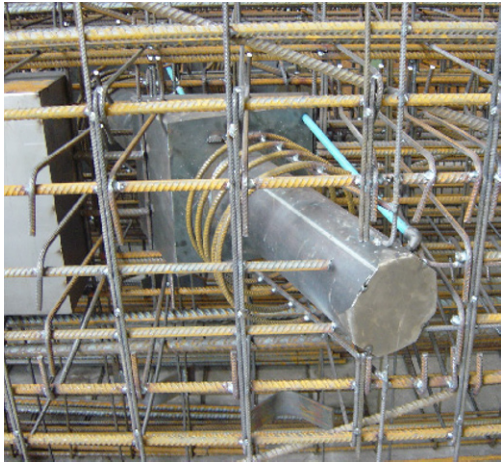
Schlitzwandkorb mit Einbauteilen
